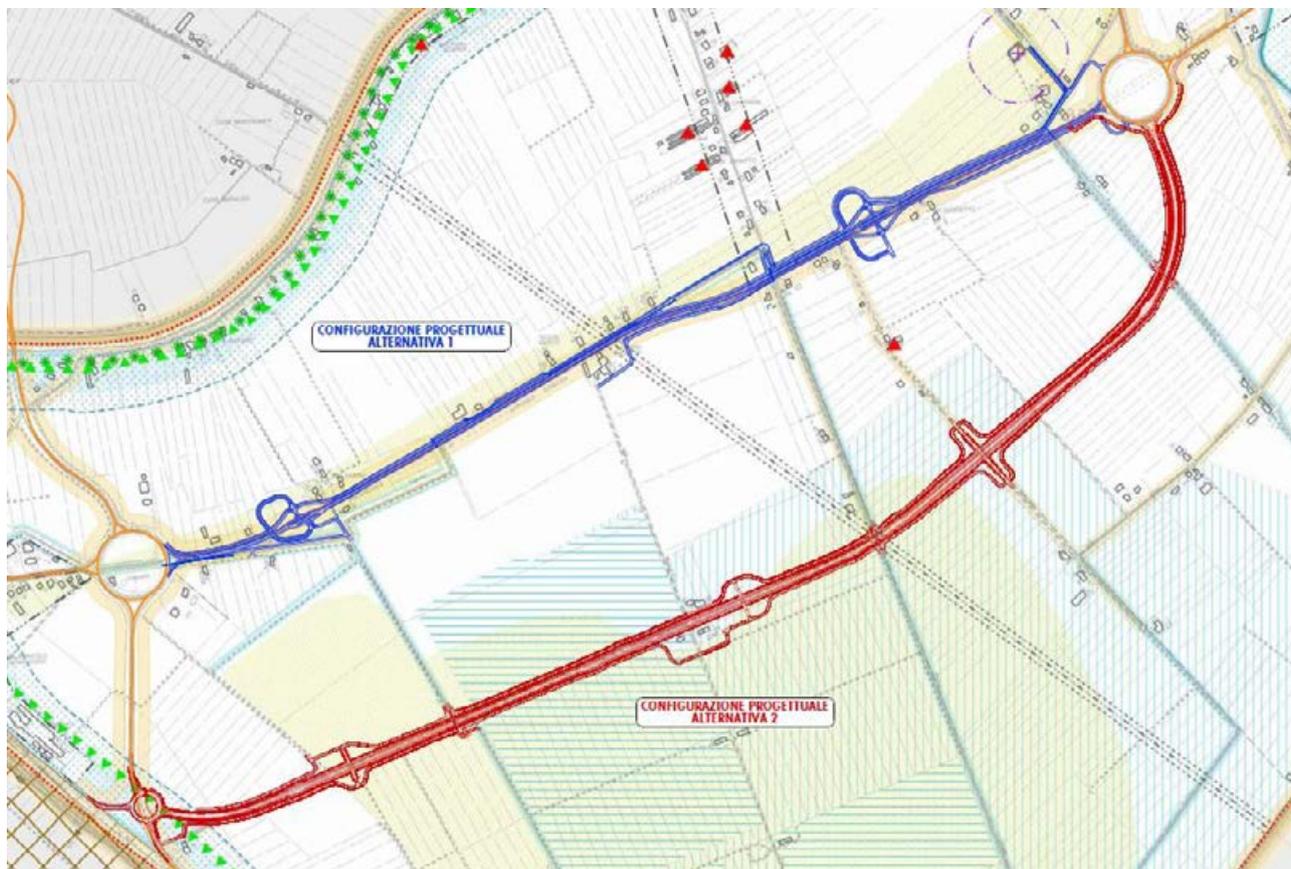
STRALCIO TAV 1 PAT SAN DONÀ DI PIAVE – LOCALITÀ ARMELLINA
